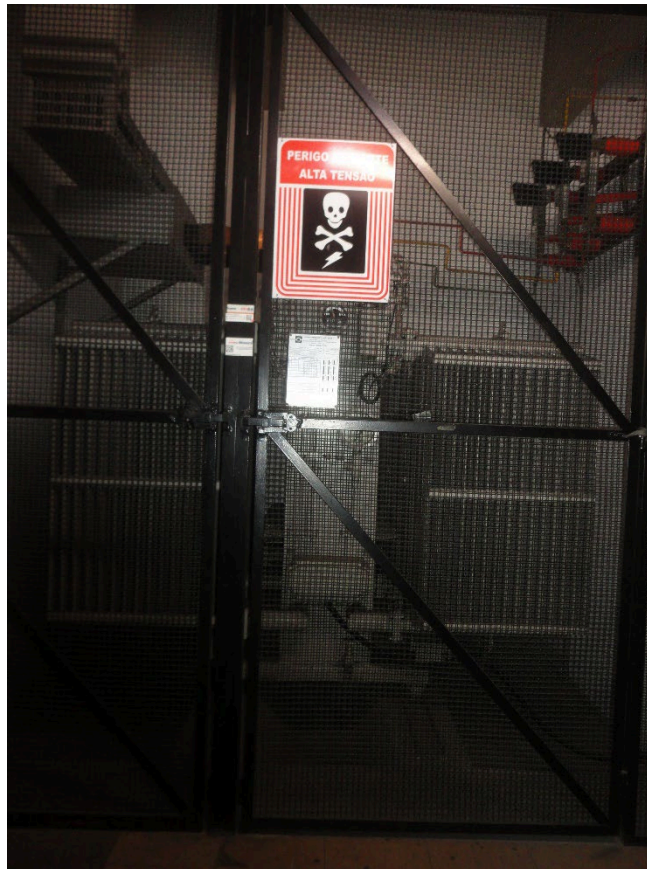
SUBSOLO – CASA DE MÁQUINAS
